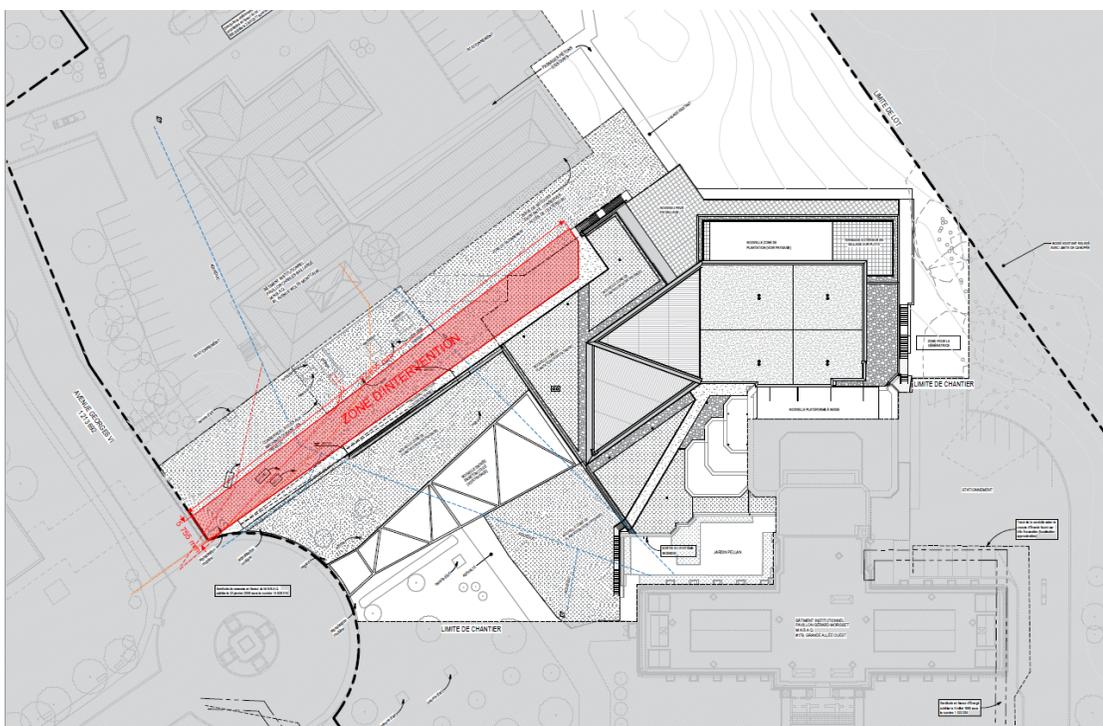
Vue en plan du lieu d'intervention choisi (voir l'encadré rouge). Voir plan détaillé en annexe.
